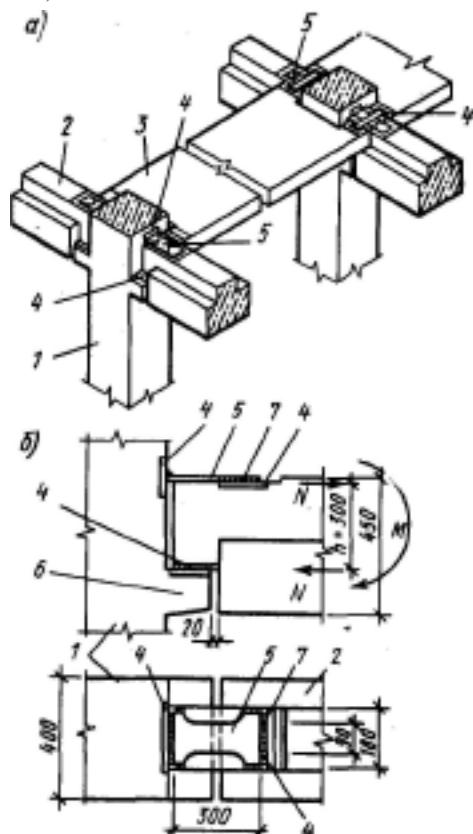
Узел опирания ригеля на колонну в унифицированном каркасе:
